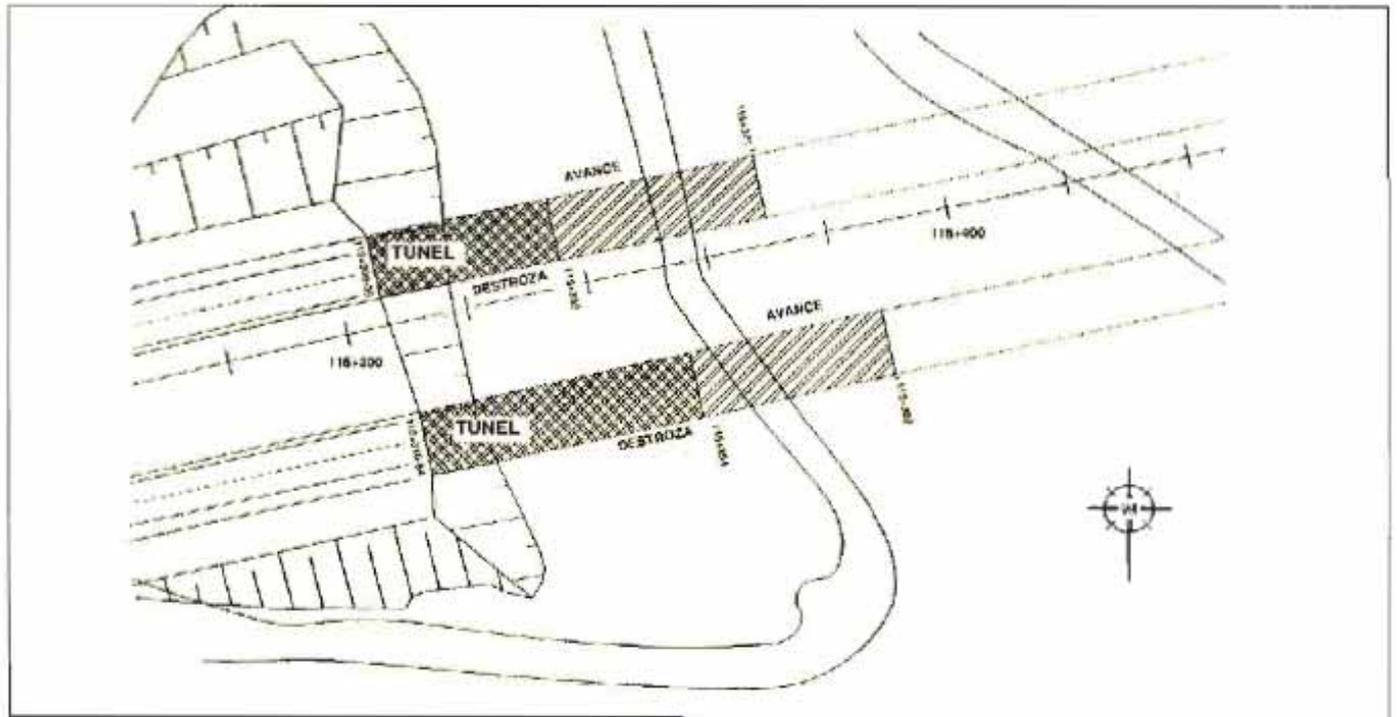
Planta de los túneles. Boca de Orense (17 abril 1995).
